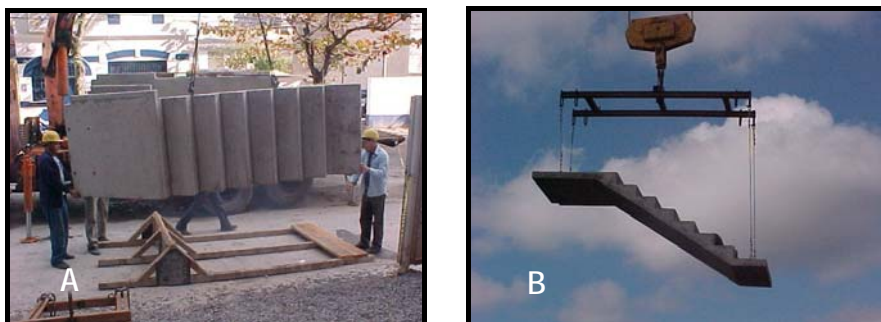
Detalhe dos elementos de suporte projetados para a montagem da escada.
